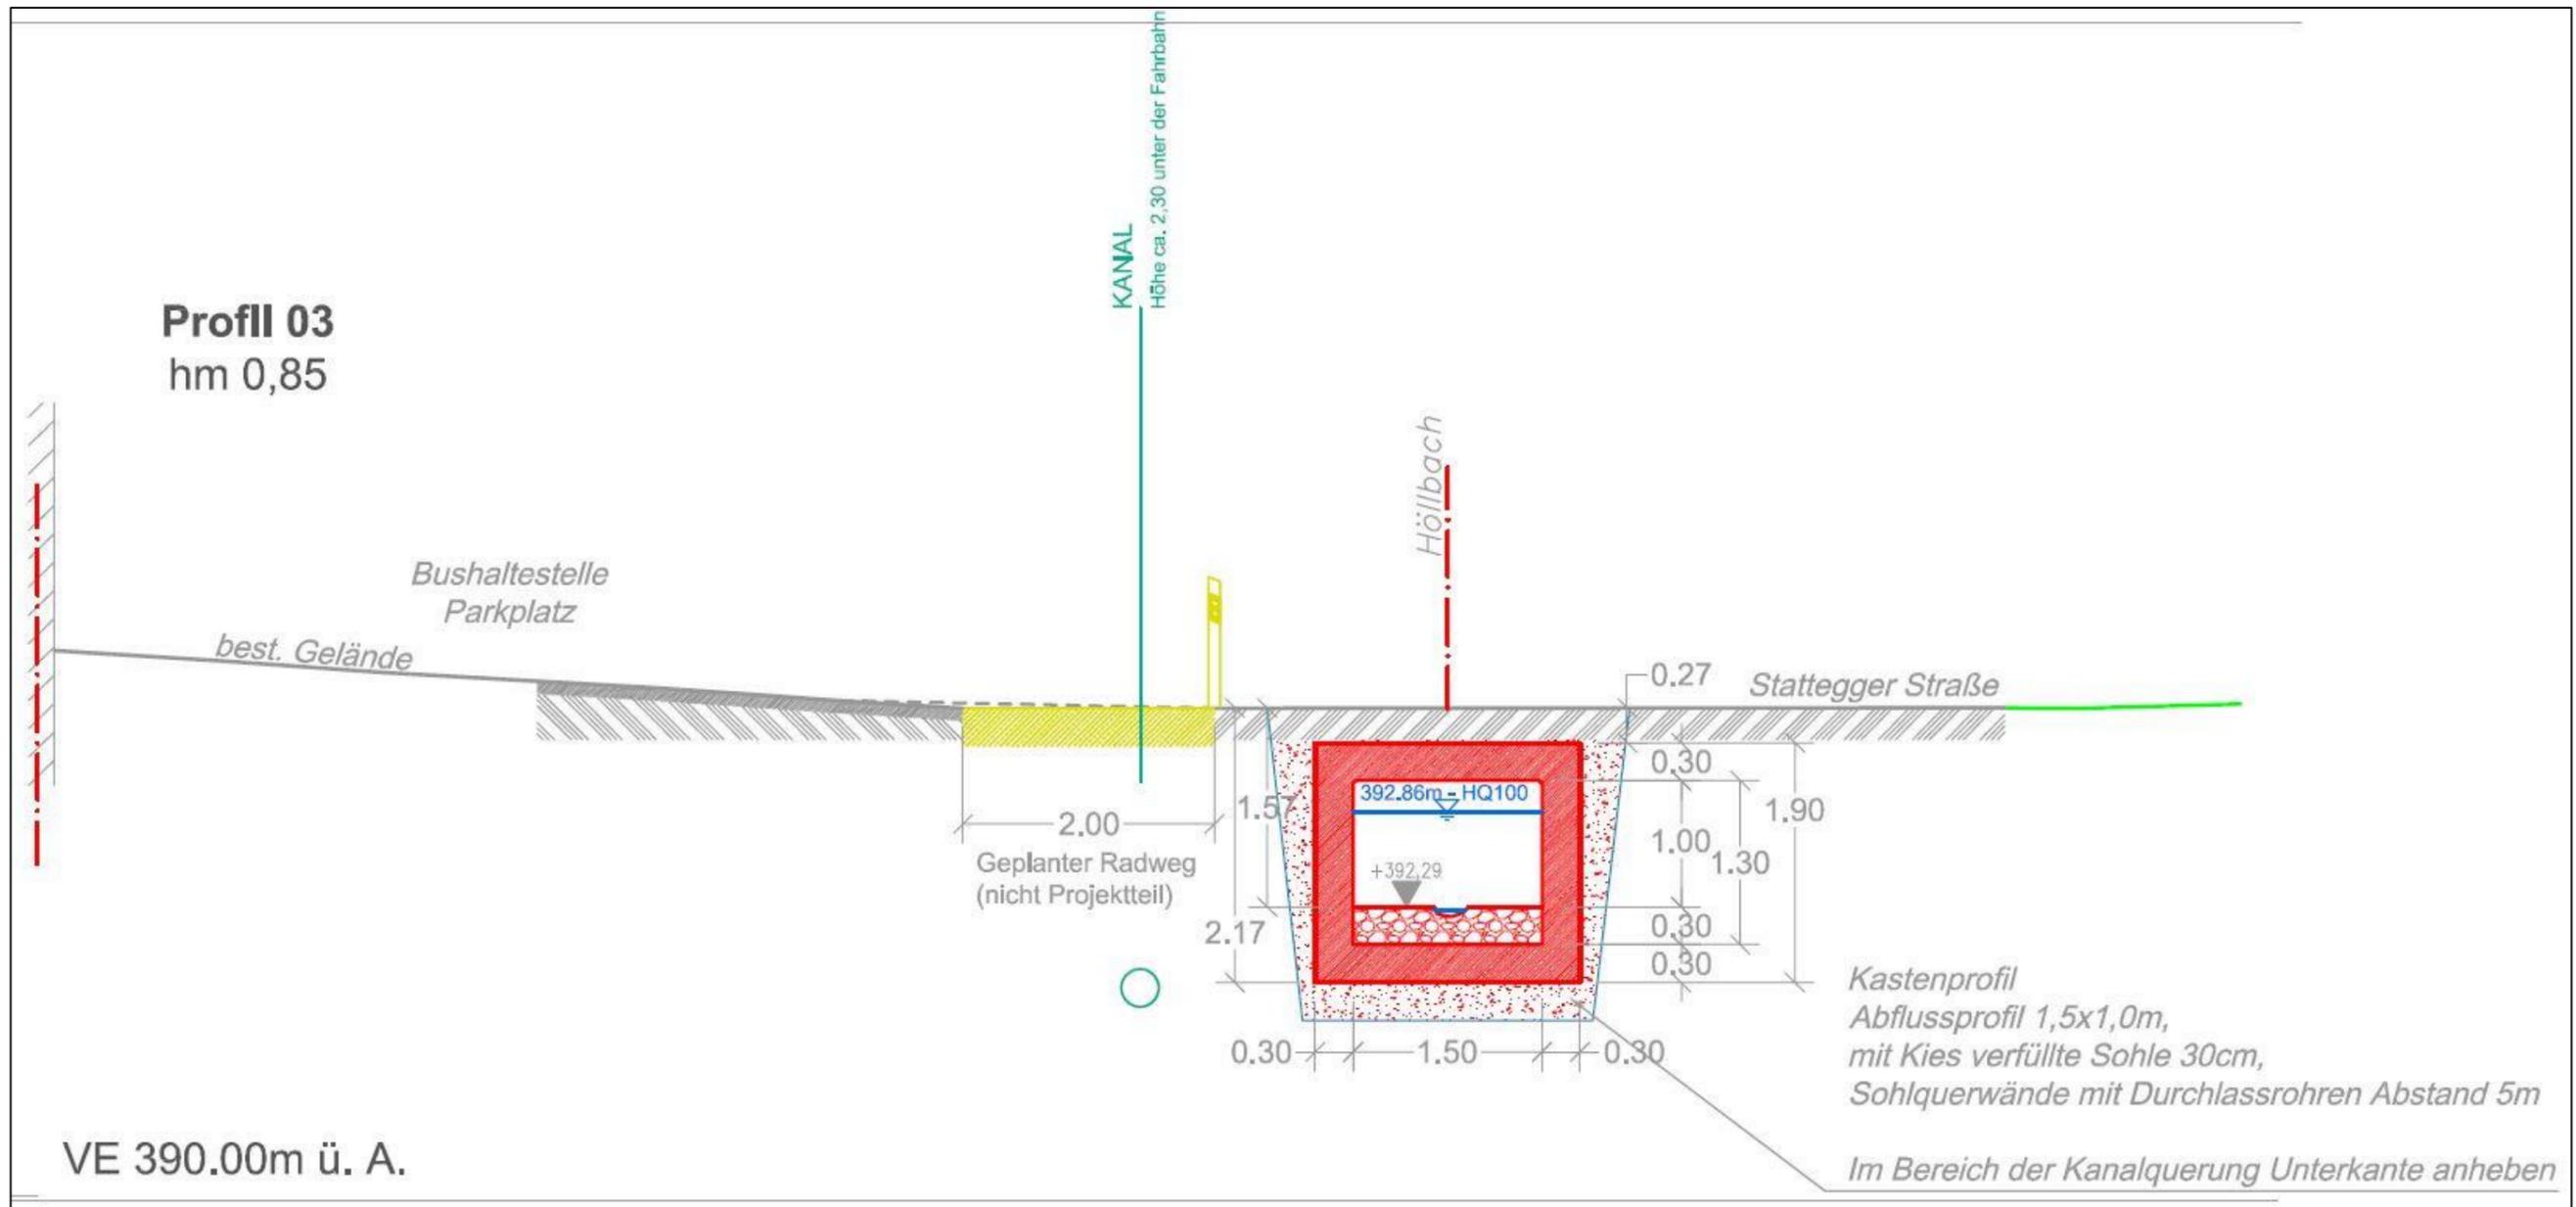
Profil 03 Höllbach (Ausschnitt aus „Schnitt Profil 1-10 Höllbach“) [Q8]
